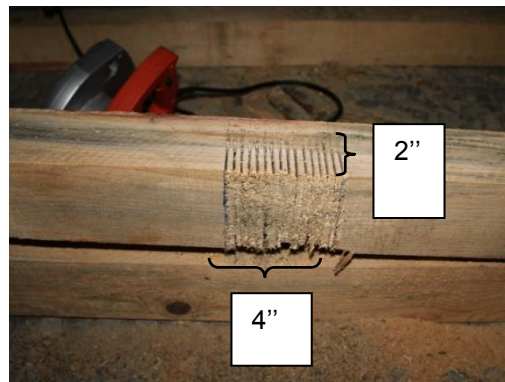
Dimensiones de empalmes en extremo de viga o columna
